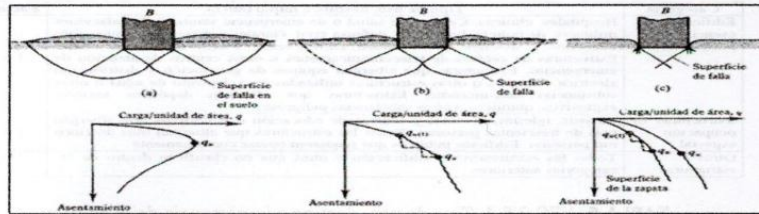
TIPOS DE FALLAS: (a) falla general por corte; (b) falla local por corte; y, (c) falla por hundimiento.
